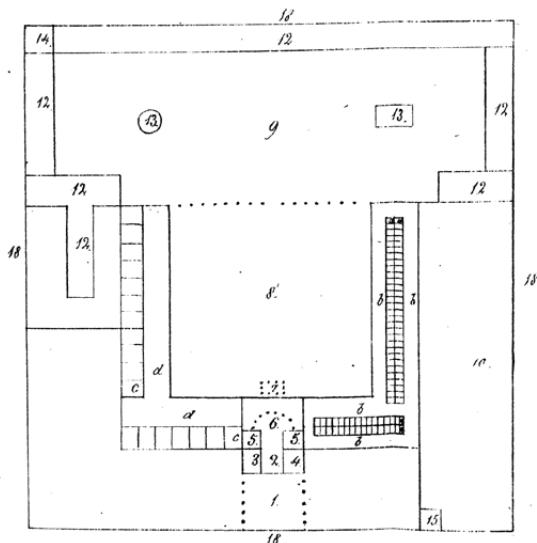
Planimetria e prospetti del carcere di Newgate (da HOWARD 1788, p. 263).
